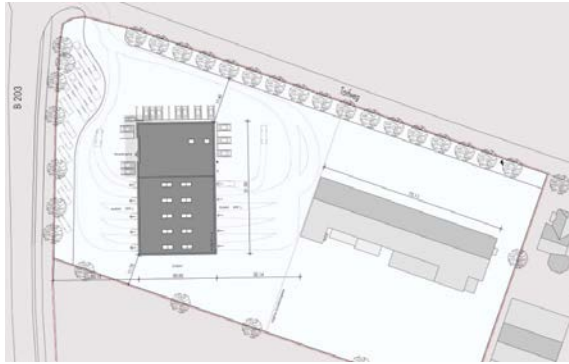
+ 12: Lagepläne der WDK Architekten +Ingenieure
